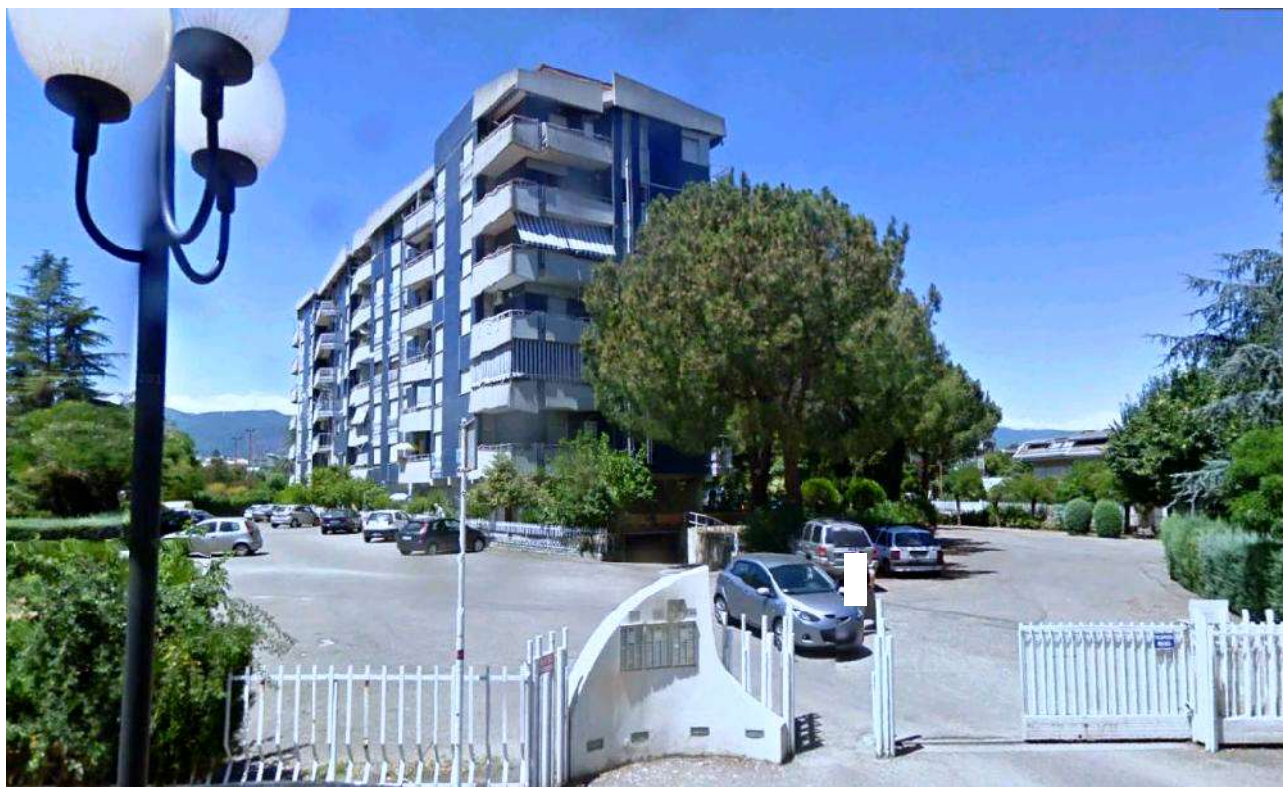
RENDE: ingresso corte comune e vista del fabbricato
